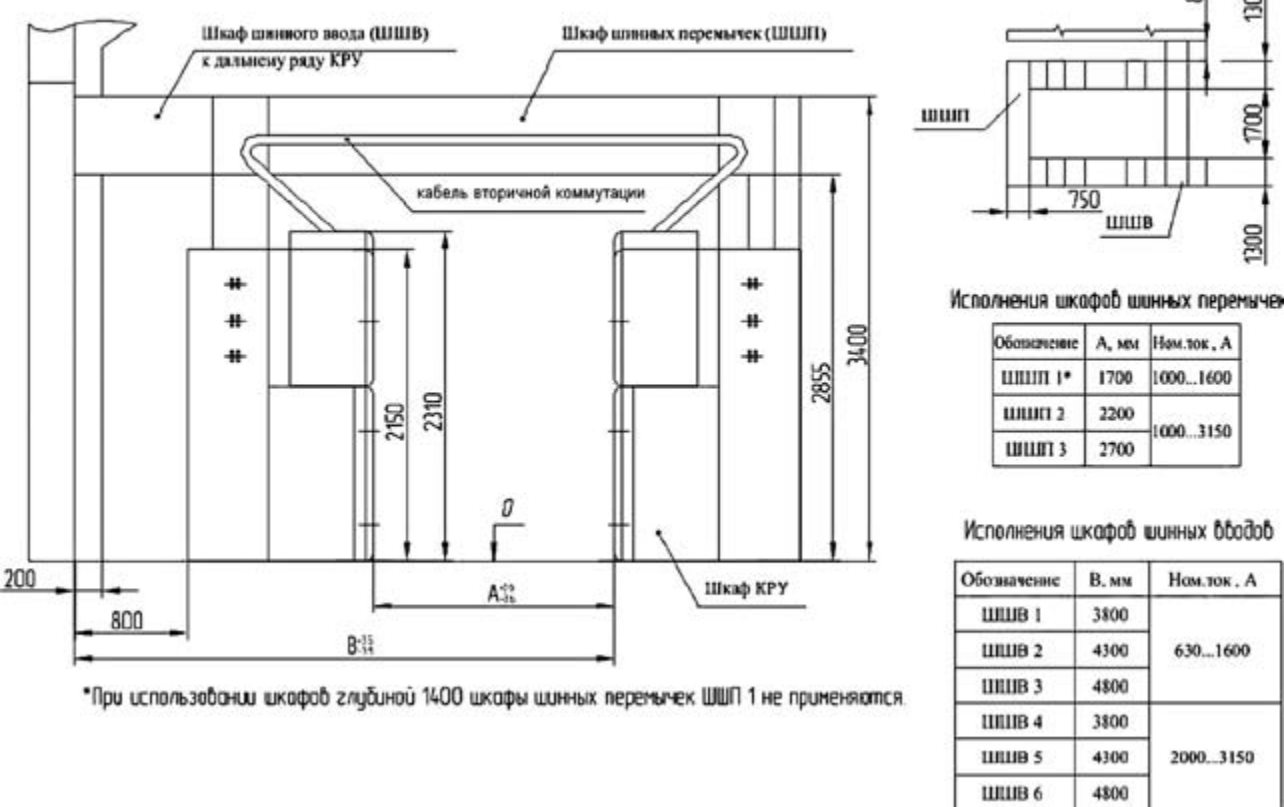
Компонировка двухрядного расположения шкафов фасадами друг к другу.
